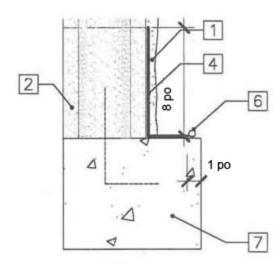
Échantillon nº 2 : Mur opaque avec pénétrations et fixations (attaches et dispositifs d'ancrage de maçonnerie) – Exemple de maintien de la continuité du système aux joints, aux pénétrations et au mur de fondation – Type de construction : Ossature d'acier avec remplissage en blocs de maçonnerie
